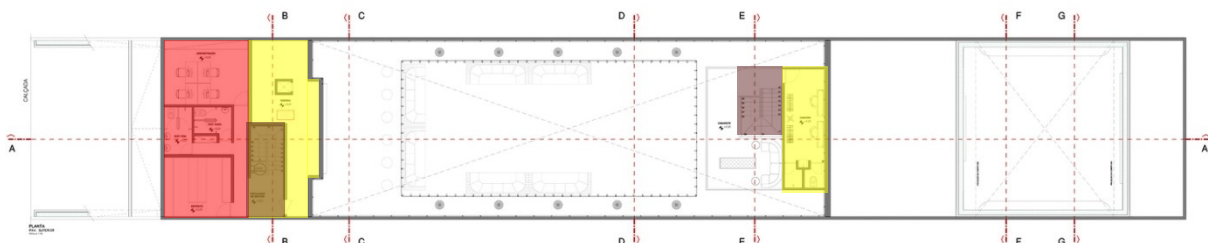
Planta do Mezanino do The Year Club onde localiza-se a parte administrativa da Casa. (Fonte: ARCHDAILY, 2016)
